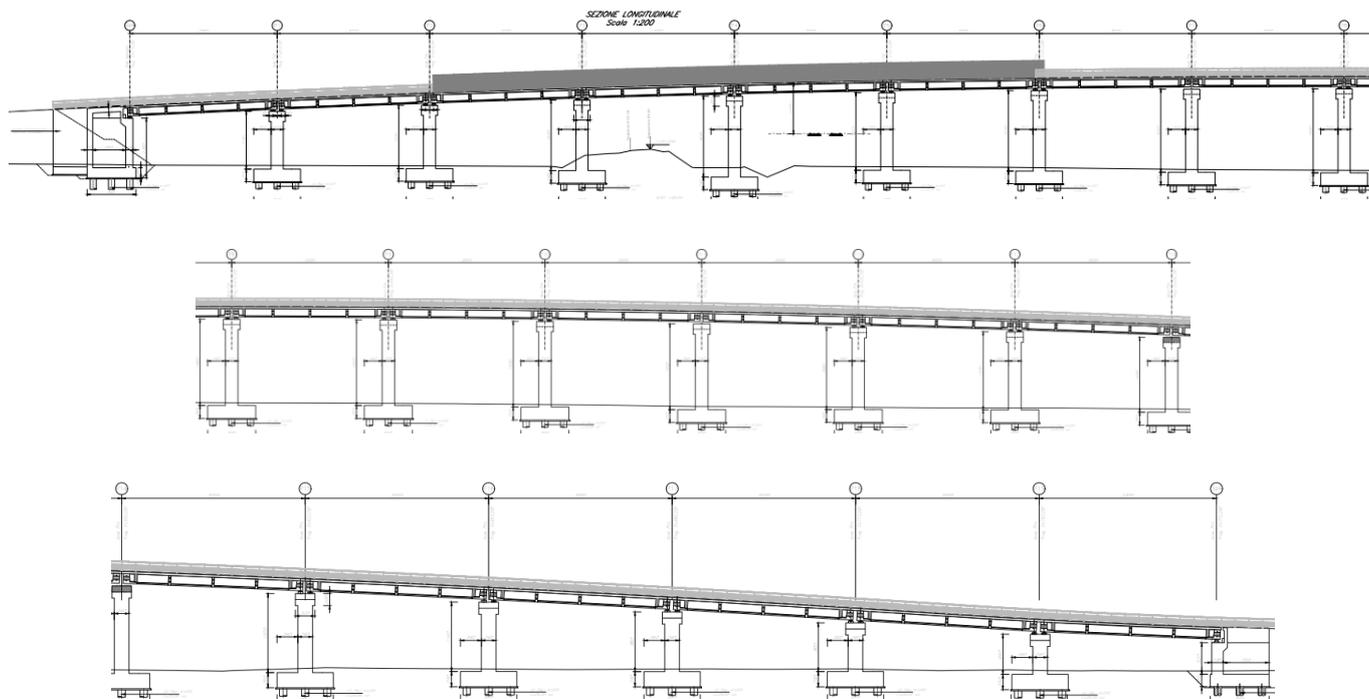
Sezione longitudinale nuovo cavalcaferrovia S.P.93
